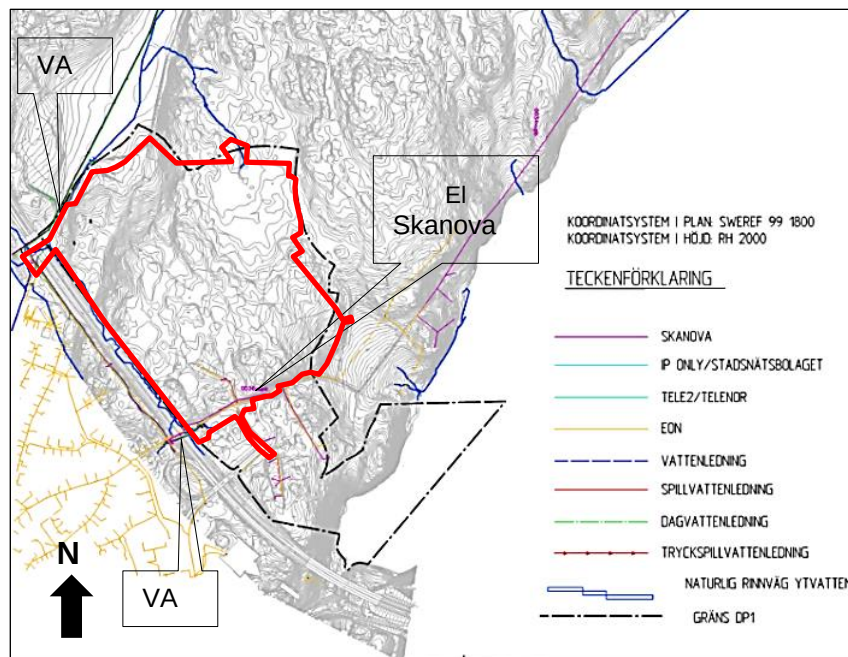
Befintliga ledningar kring planområdet. Detaljplanegränsen visas i rött.
